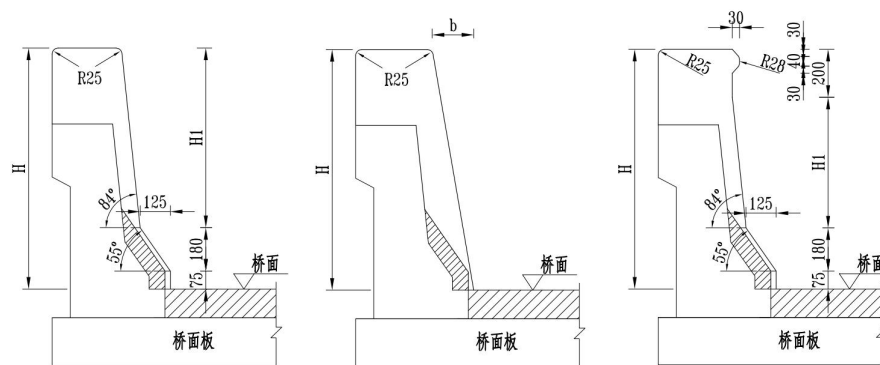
包封混凝土桥梁护栏改造方案
